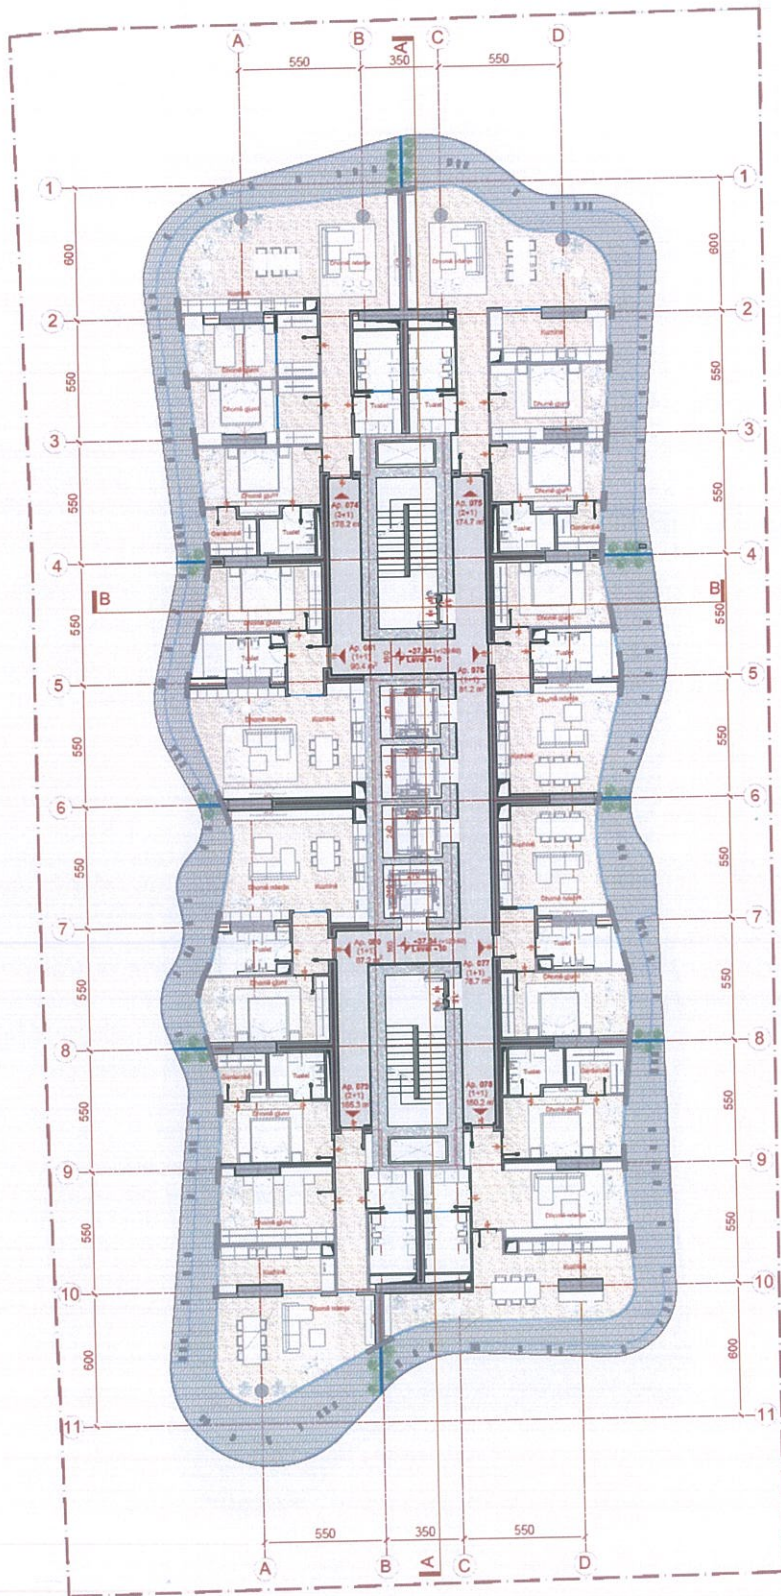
Planimetri e katit të dhjetë (Rezidencë).
